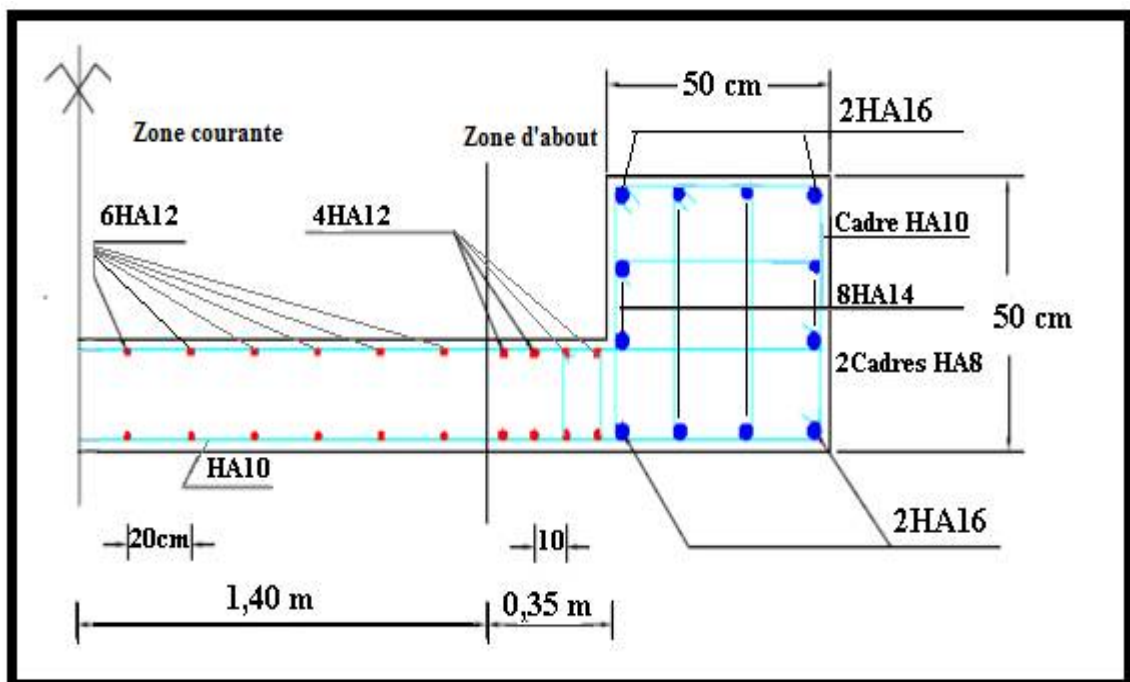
Schéma de ferrailage longitudinal de l'ensemble du Poteau (RDC) et de voile V3.
